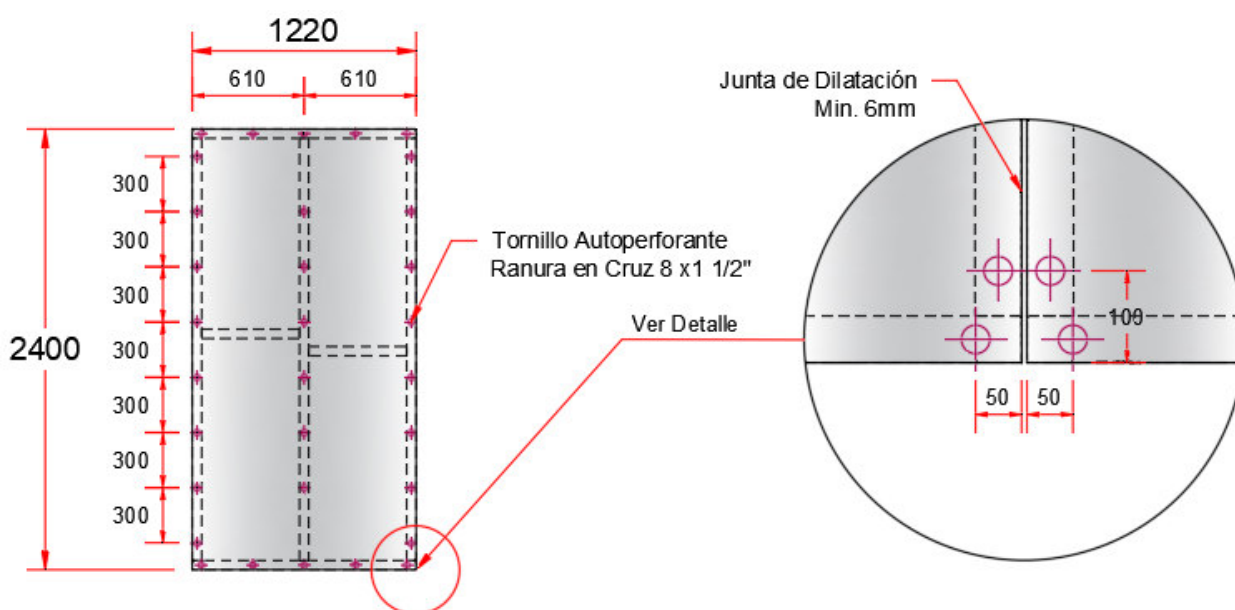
Panel Muro Estándar del Sistema de Entramados de Madera
